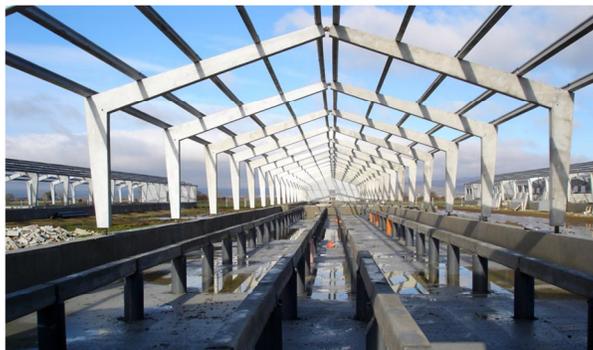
Pórticos y Correas en concreto prefabricado, como apoyo de cubierta.
